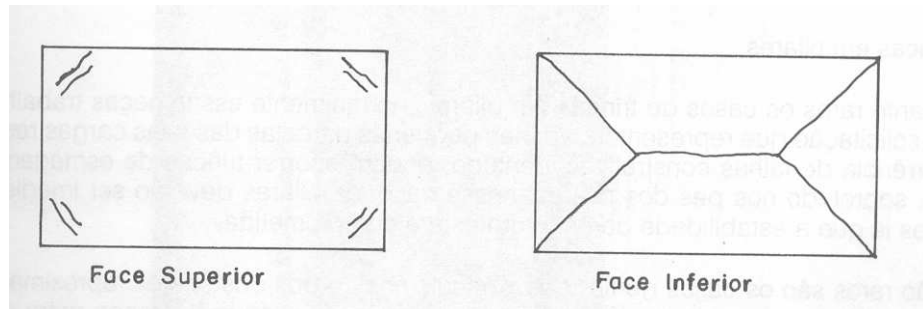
Fissuramento típico em lajes simplesmente apoiadas.
